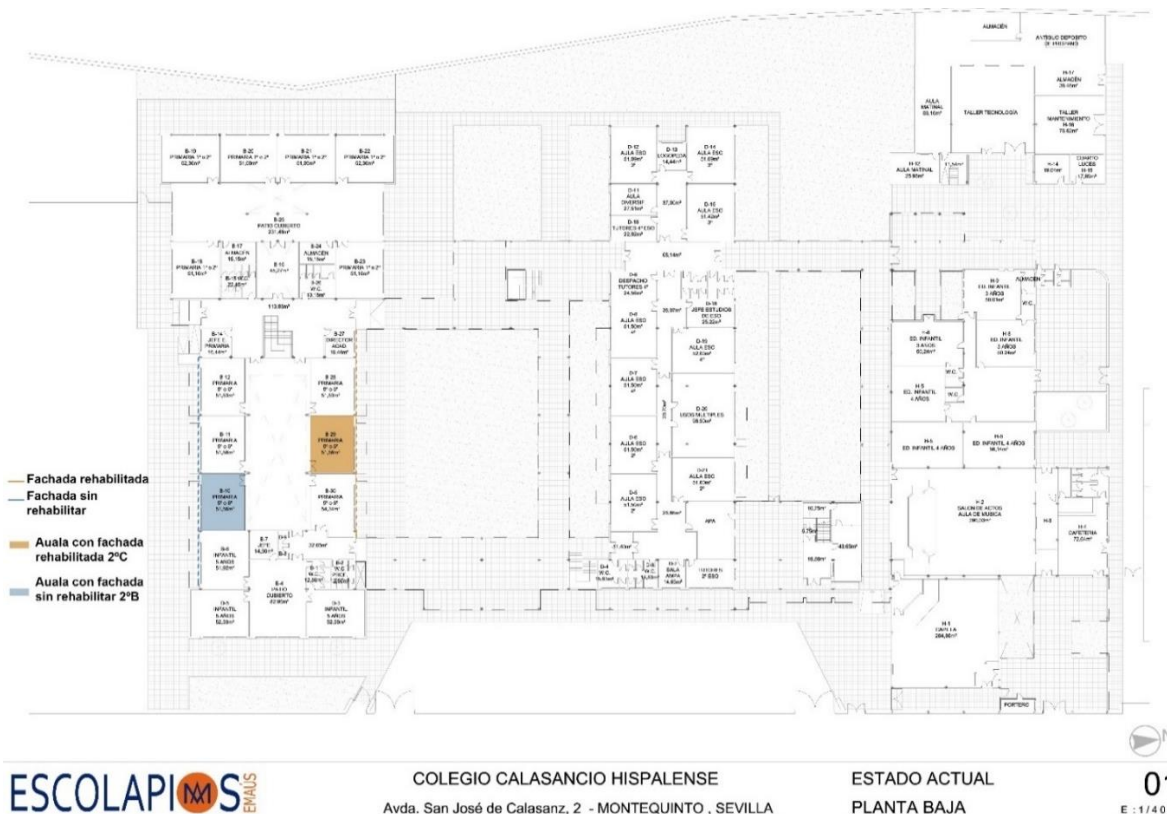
Planta baja del CEIP Calasancio Hispalense y ubicación de las aulas de estudio. Planos aportados por el centro. Fuente: Escolapios Emaús
